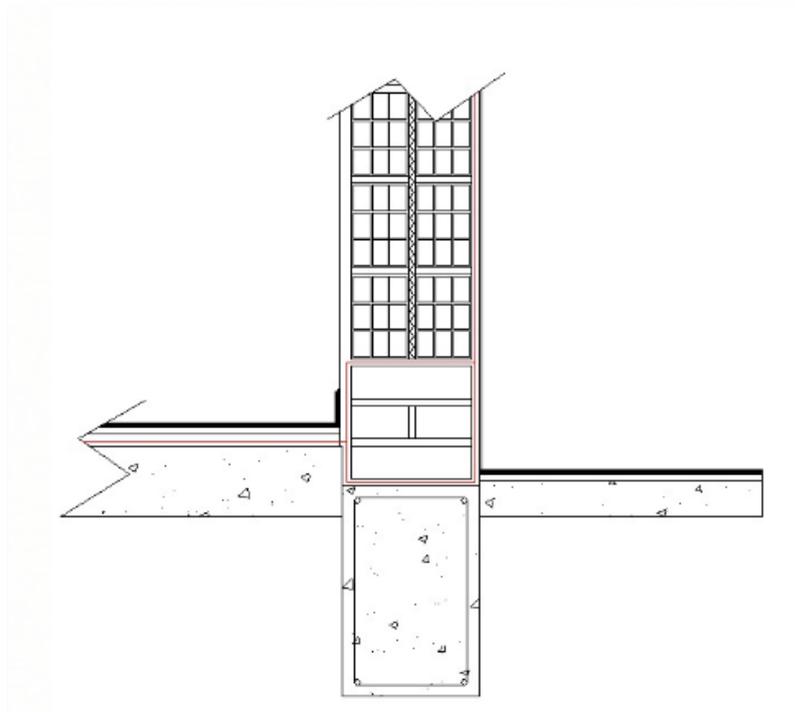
Muro de ladrillo hueco doble y cámara de aislamiento interior. Fuente: propia.
